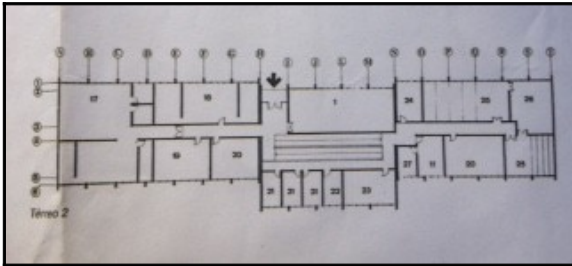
Planta do pavimento intermediário – PROJETO, São Paulo, set. 1993.
